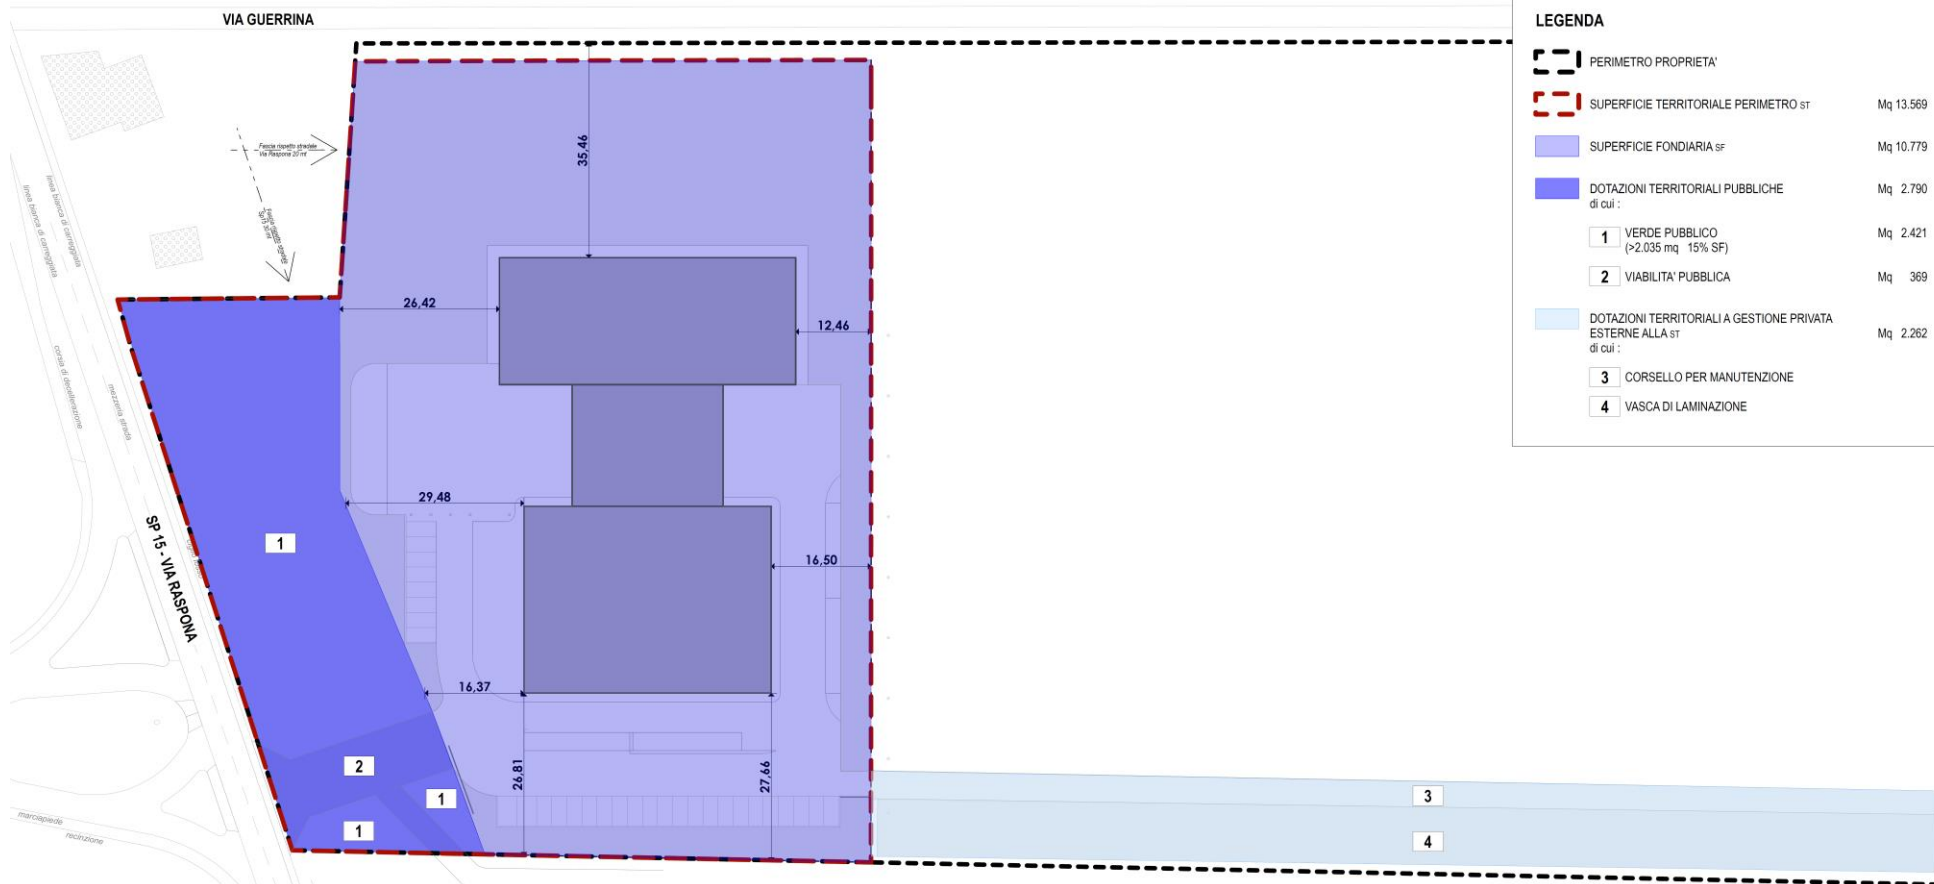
Planimetria generale urbanistica Consorzio agrario
